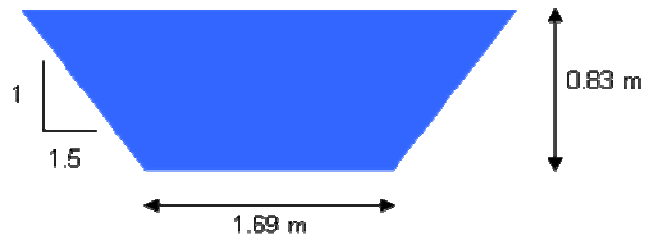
Section critique de 2,24 m<sup>3</sup>/s (rivière à l'Orme)
